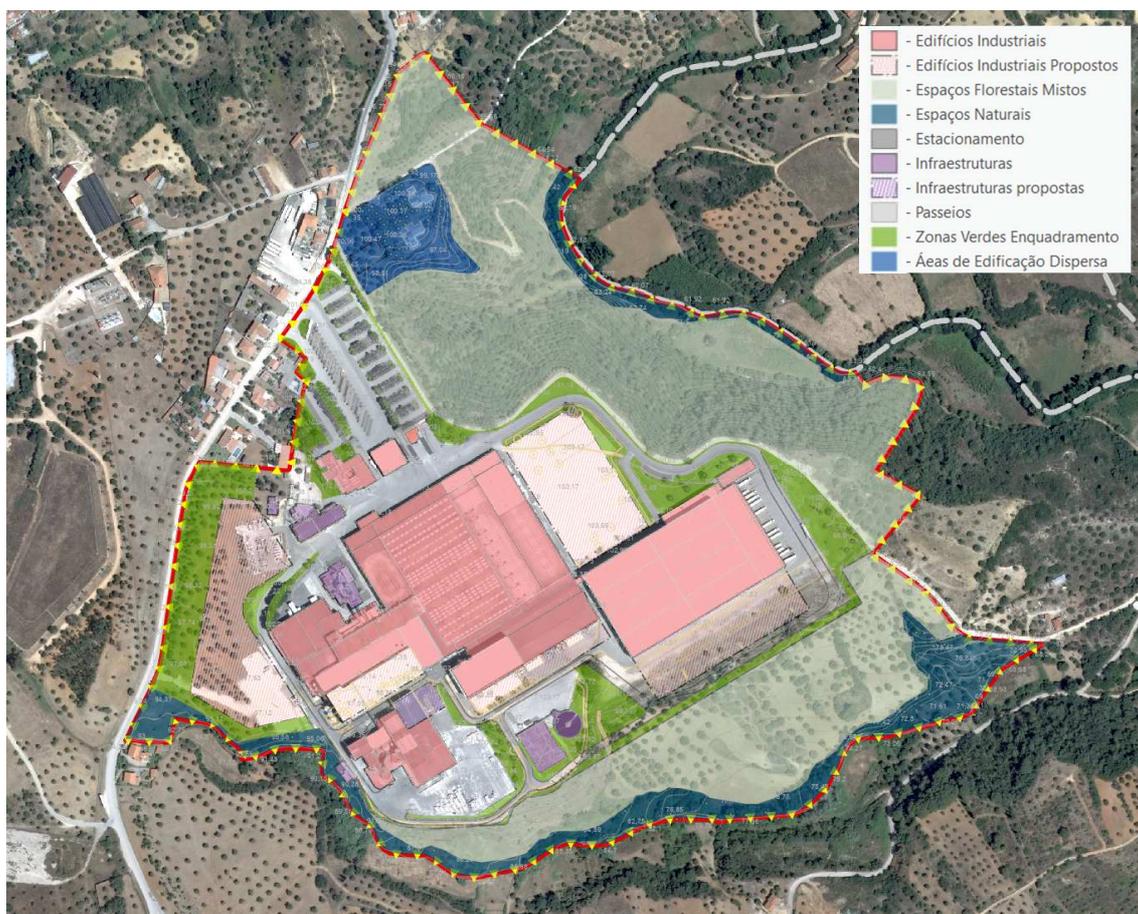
Planta de Implantação do Plano de Pormenor em vigor
